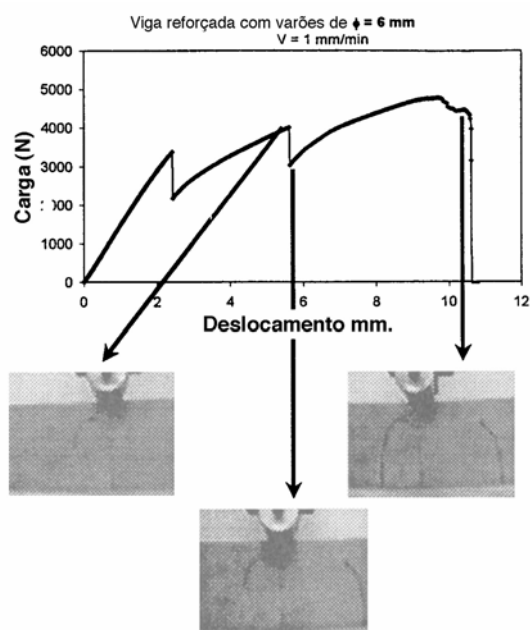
Propagação da fenda para uma viga reforçada com varões de plástico reforçado com fibra de vidro de 6 mm de diâmetro
